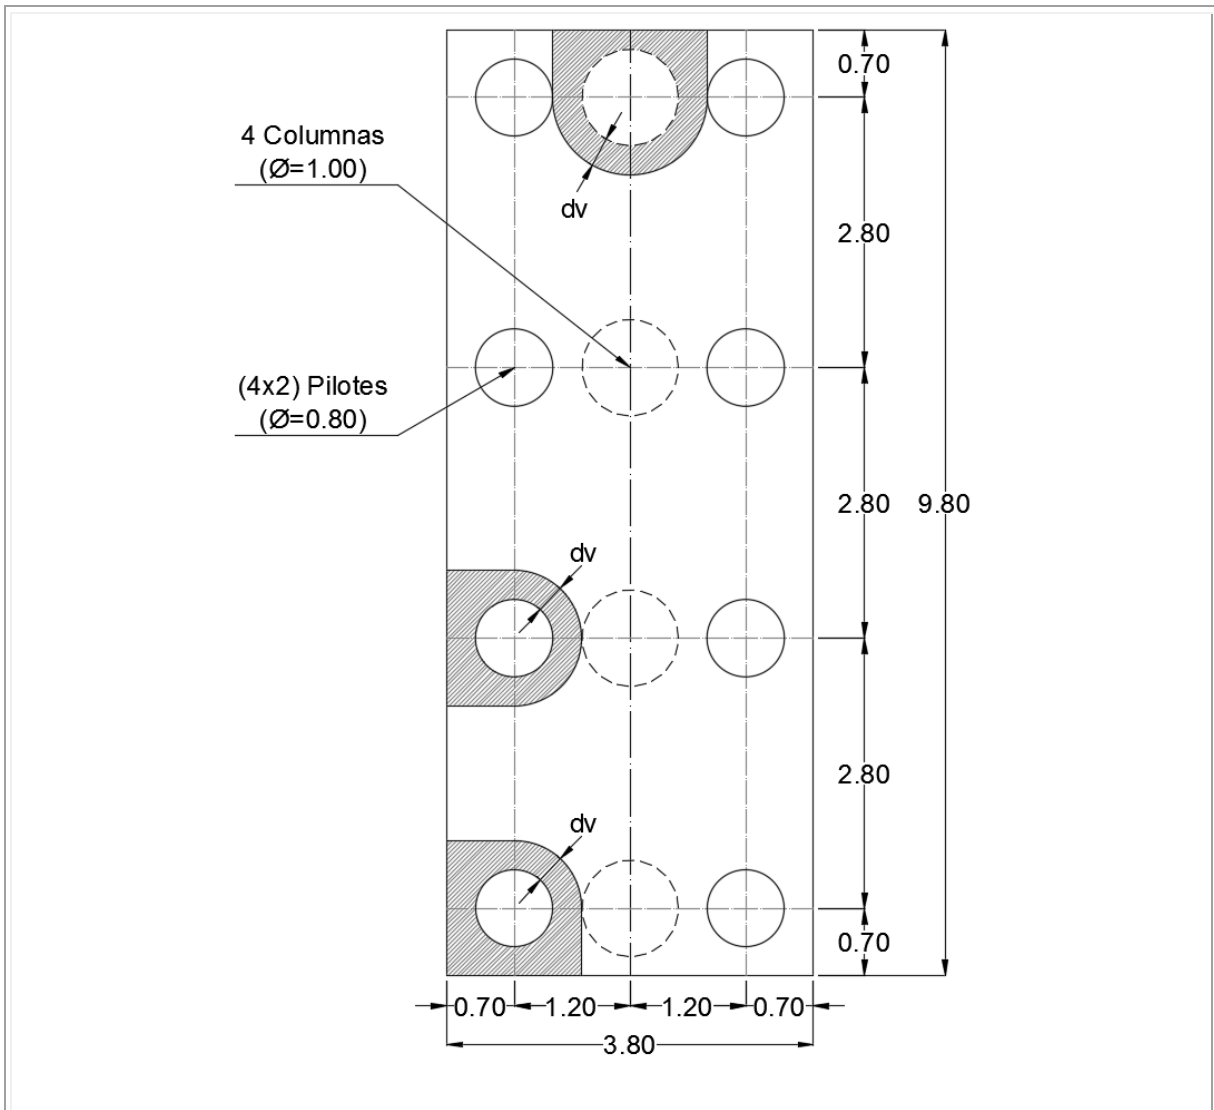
Planta del Cabezal y Zona de Punzonamiento
